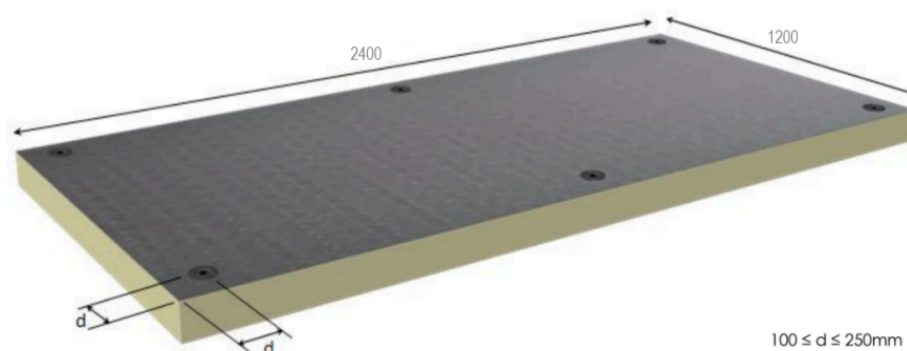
Figura . Planchas 2400 x 1200 mm: 2 fijaciones/m².
